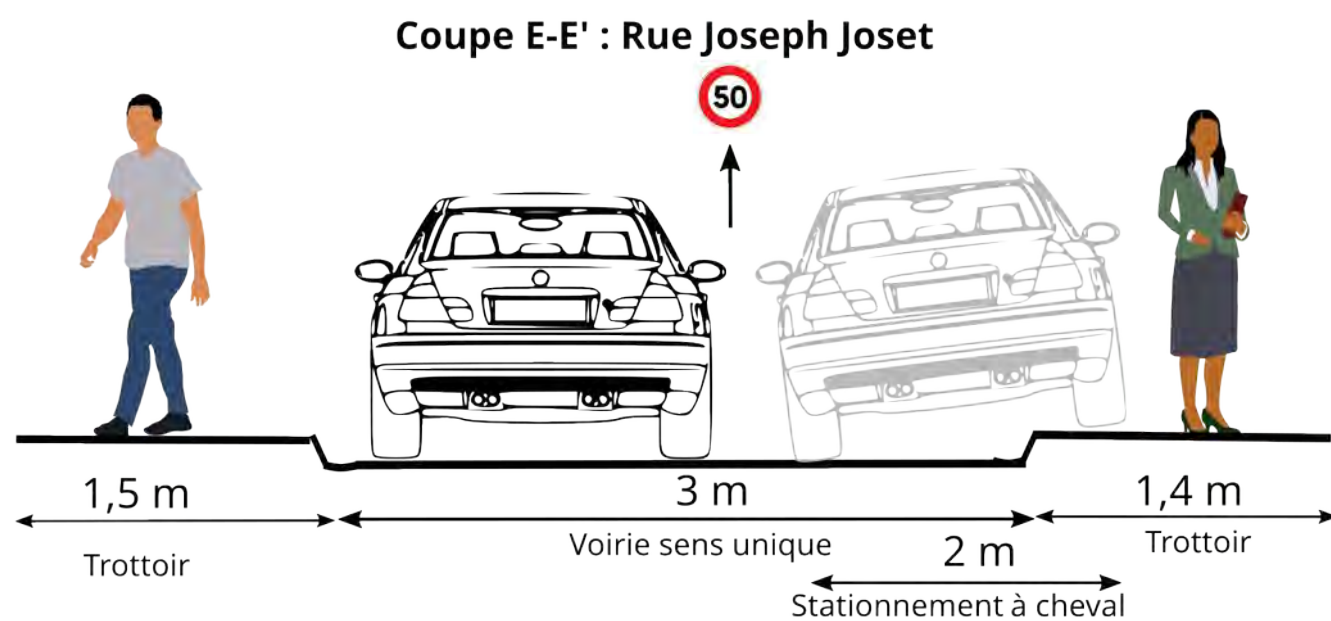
Coupe E-E' – Rue Joseph Joset
